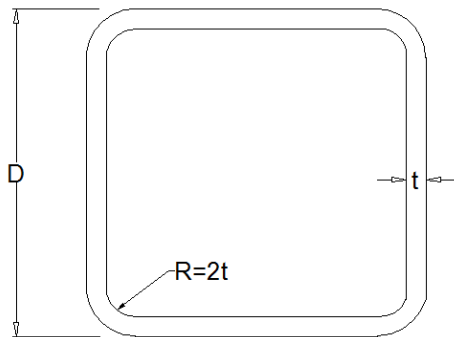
Sección de un perfil cuadrado. AutoCAD.
